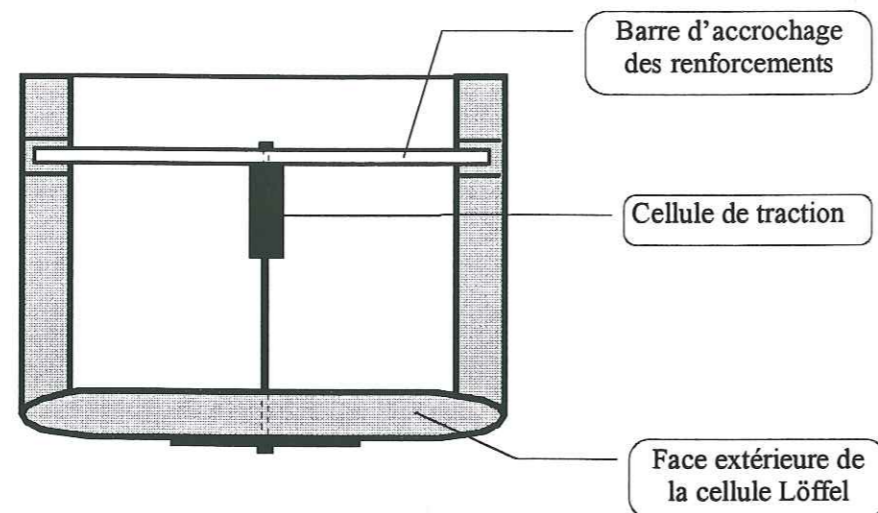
Dispositif de mesure de traction parement / renforcement - Vue en plan d'une pierre Löffel instrumentée
